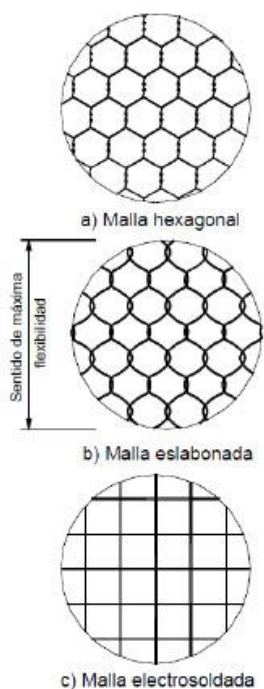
Tipos de mallas utilizadas en la construcción de gaviones. Fuente: (Suárez Díaz, 2001).
